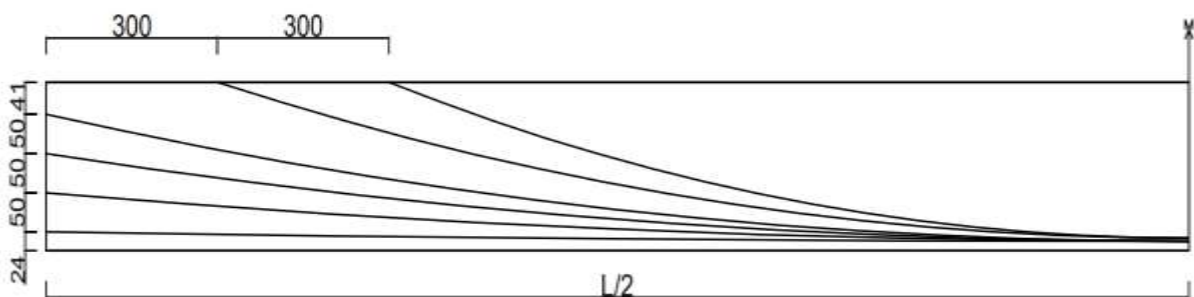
schéma du câblage longitudinal de la poutre précontrainte sur la demi-longueur.
